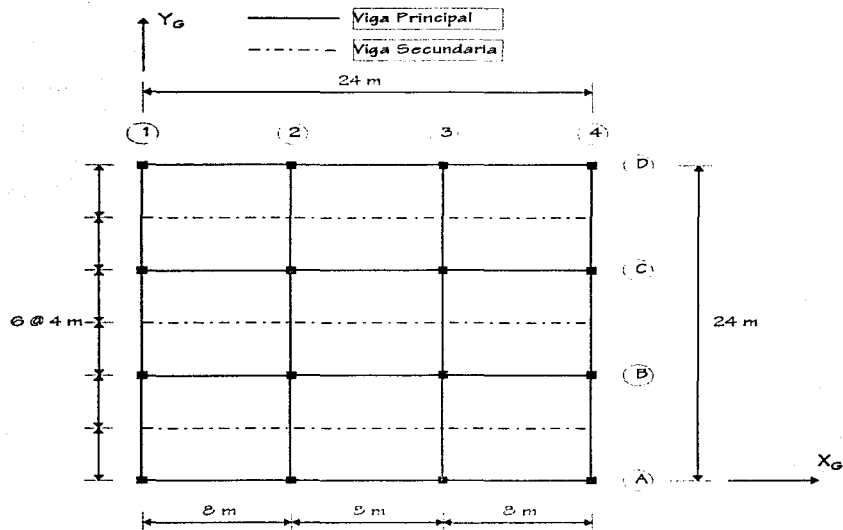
Planta tipo, estructuras de 7 y 17 niveles
